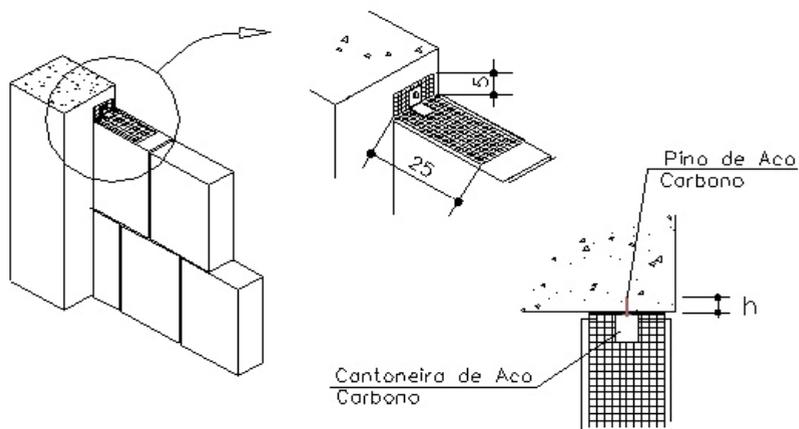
Detalhe de ligação de reforço entre parede e estrutura.
